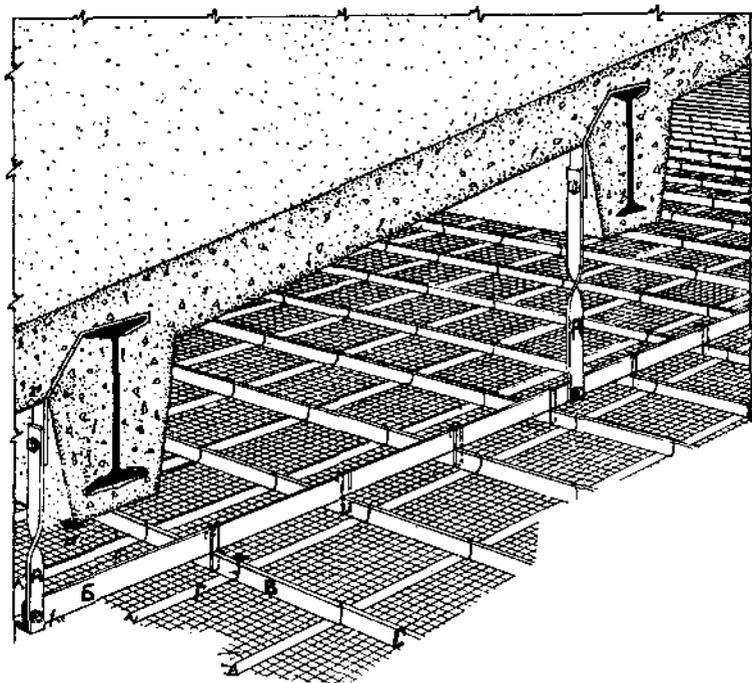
Железобетонные своды с тепловой изоляцией металлических балок.
